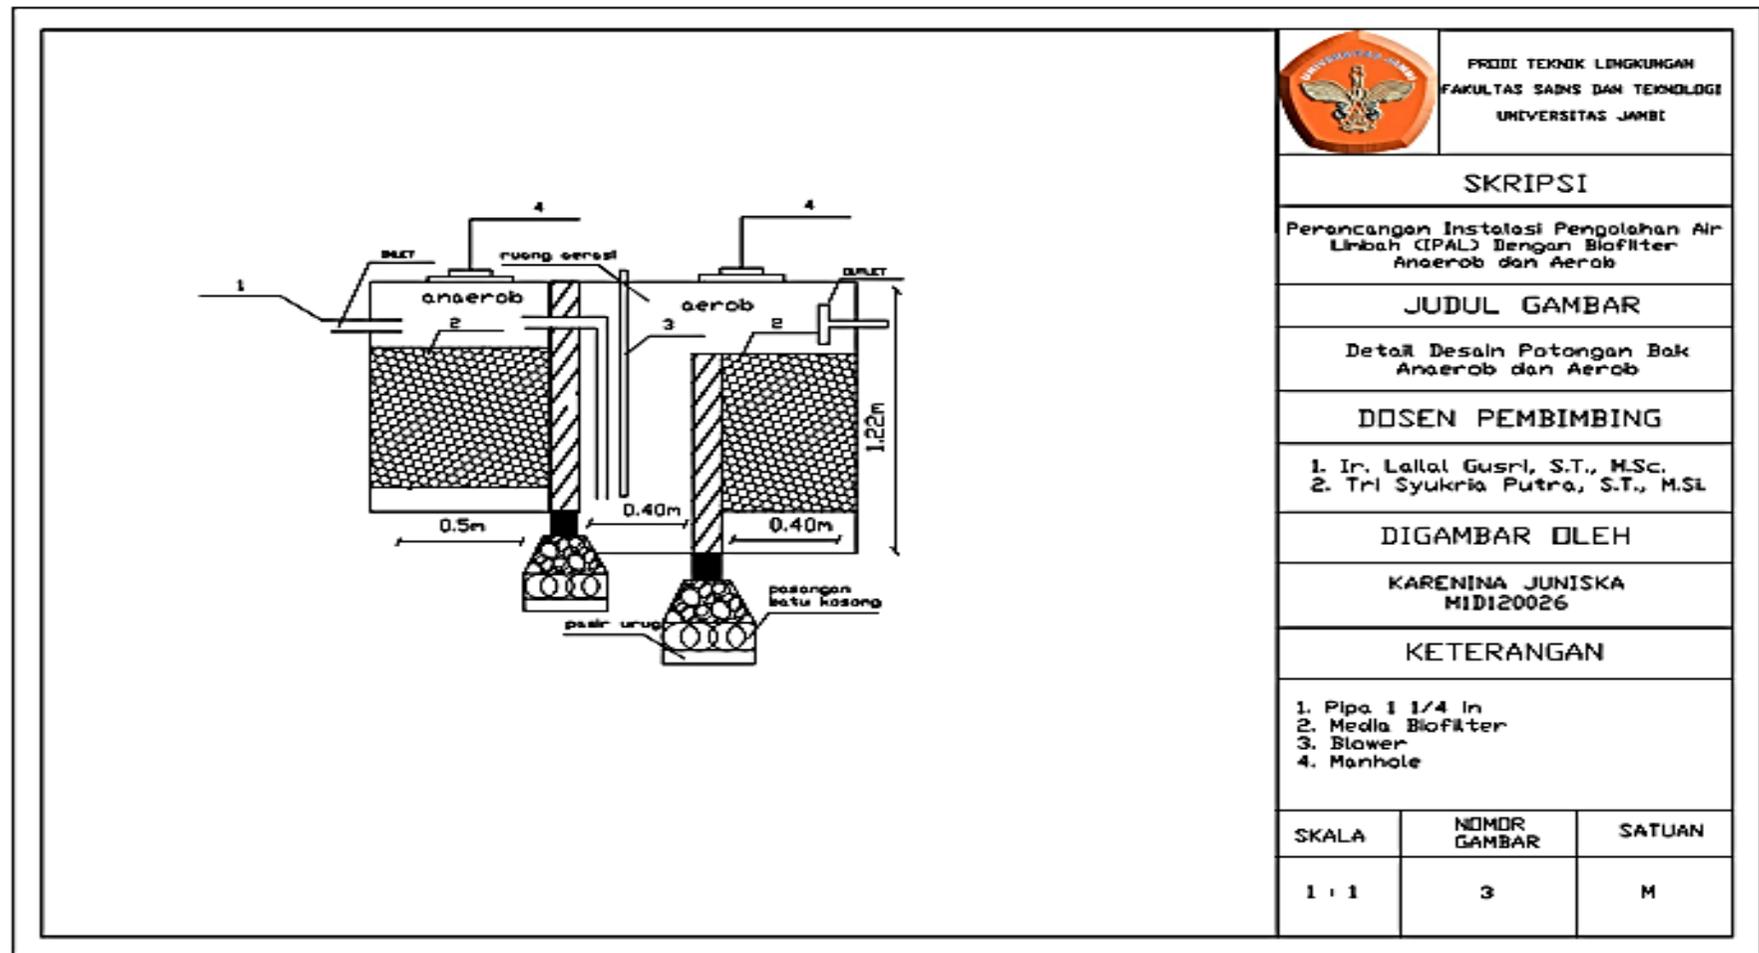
Detail Desain Potongan Bak IPAL Dengan Biofilter Anaerob dan Aerob
